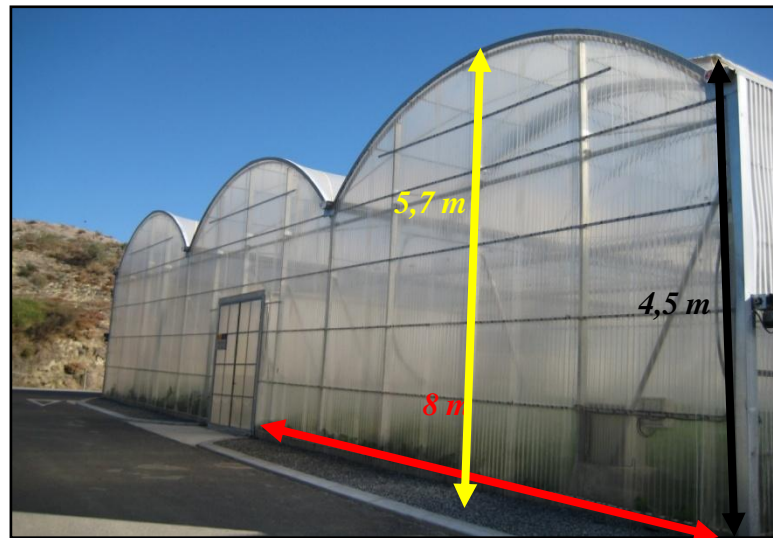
Croquis de las dimensiones estructurales de los invernaderos
